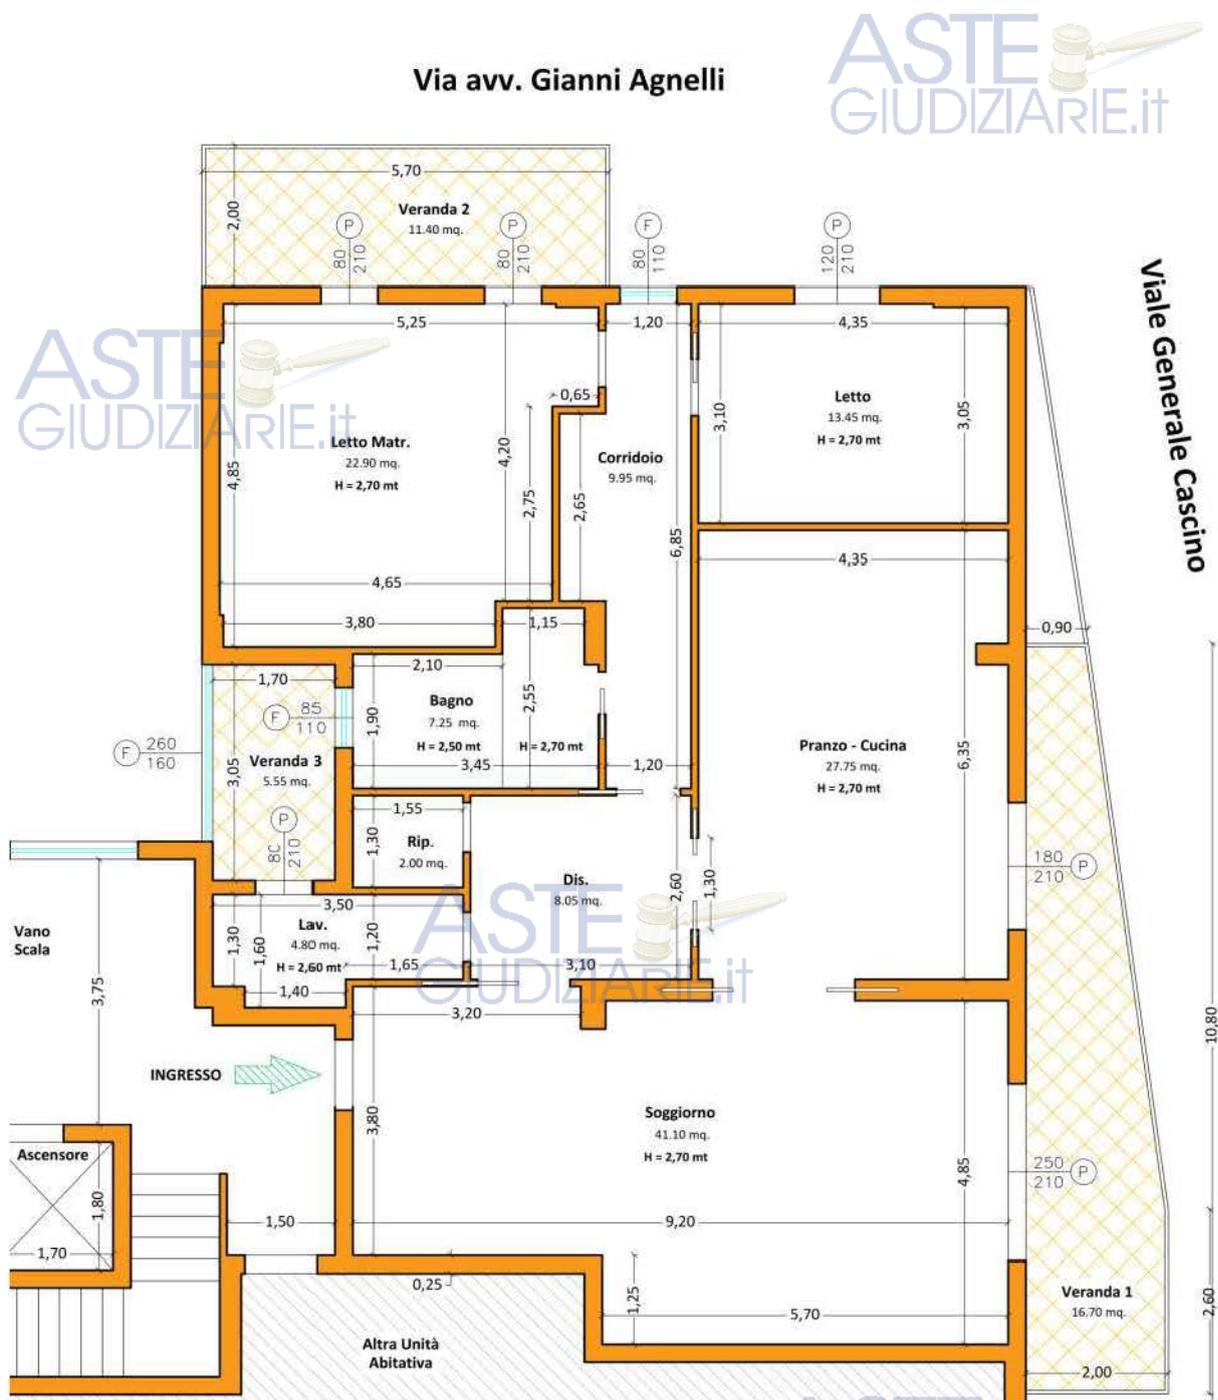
Planimetria dell'unità immobiliare oggetto di stima - Sub 63 - Primo Piano
